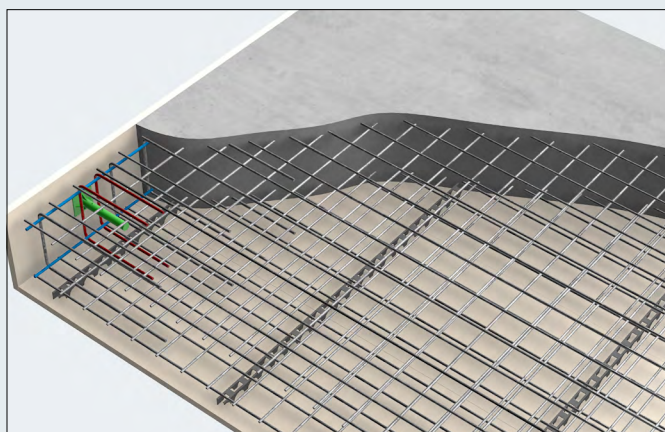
Nach Bewehrungskontrolle die Platte betonieren.
